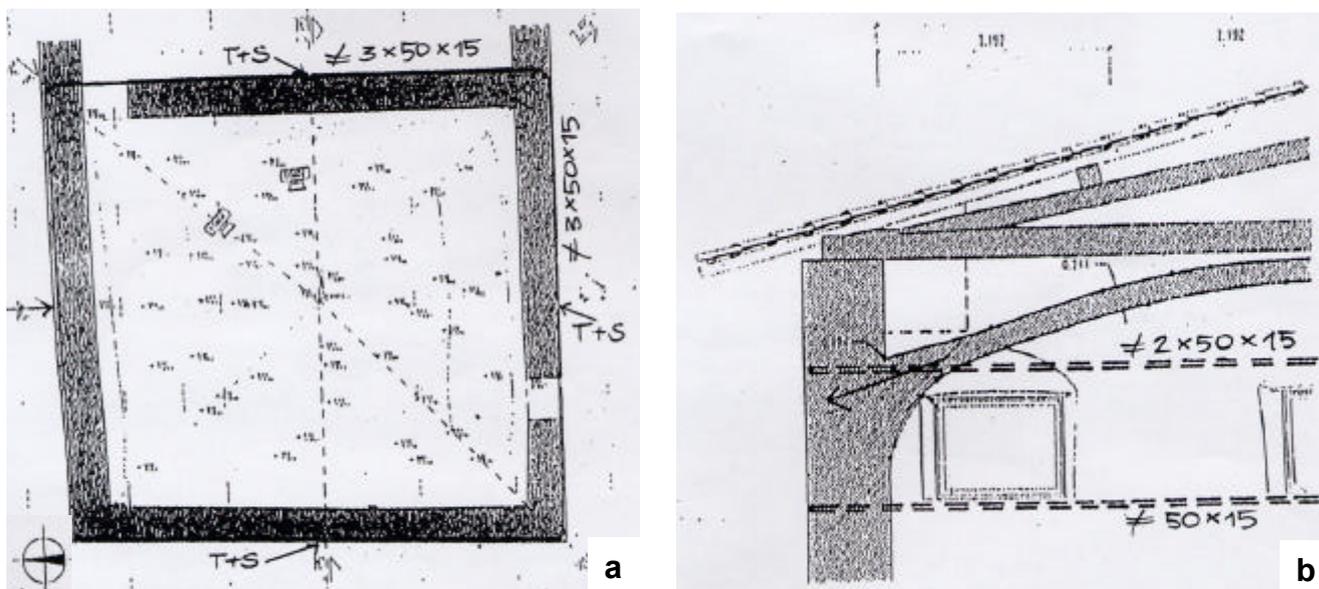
Trento, casa Pretto: a) pianta dell'estradosso della volta; b) sezione trasversale con indicazioni dell'intervento proposto.
